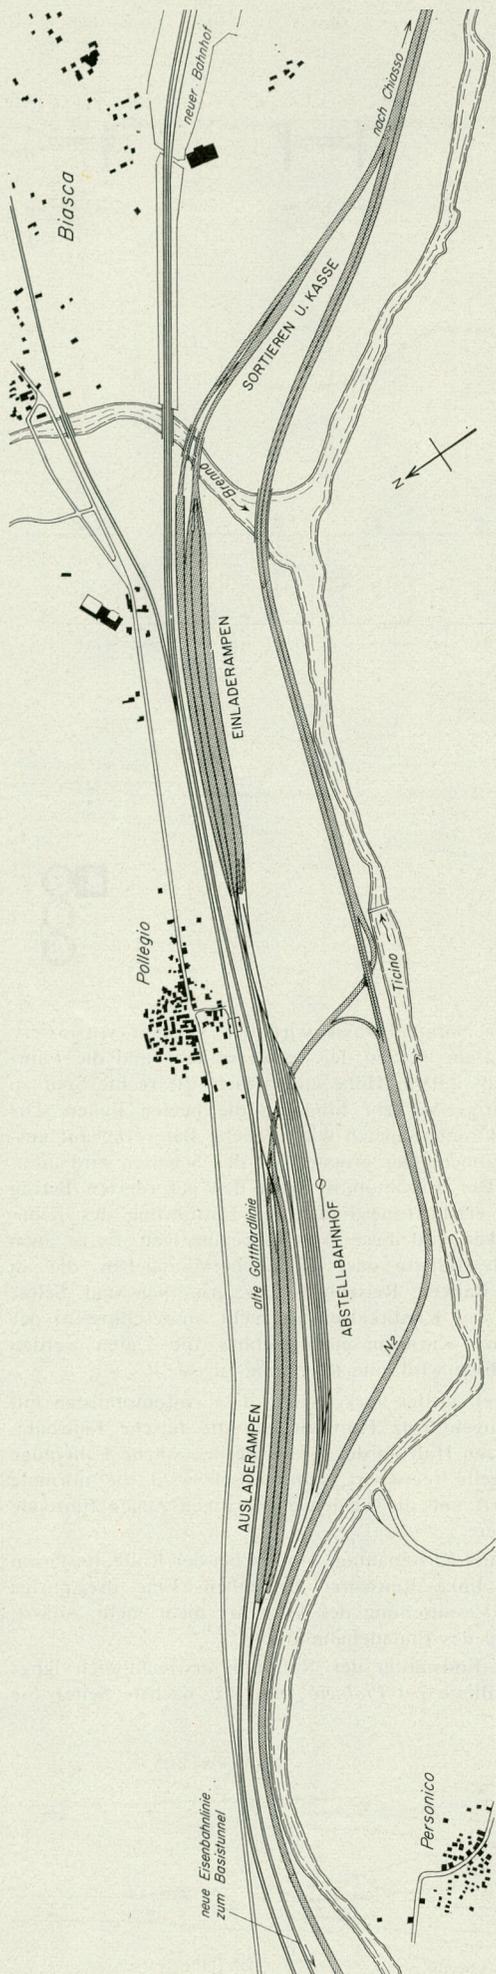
Verladebahnhof Pollegio, Lageplan 1:17 500
